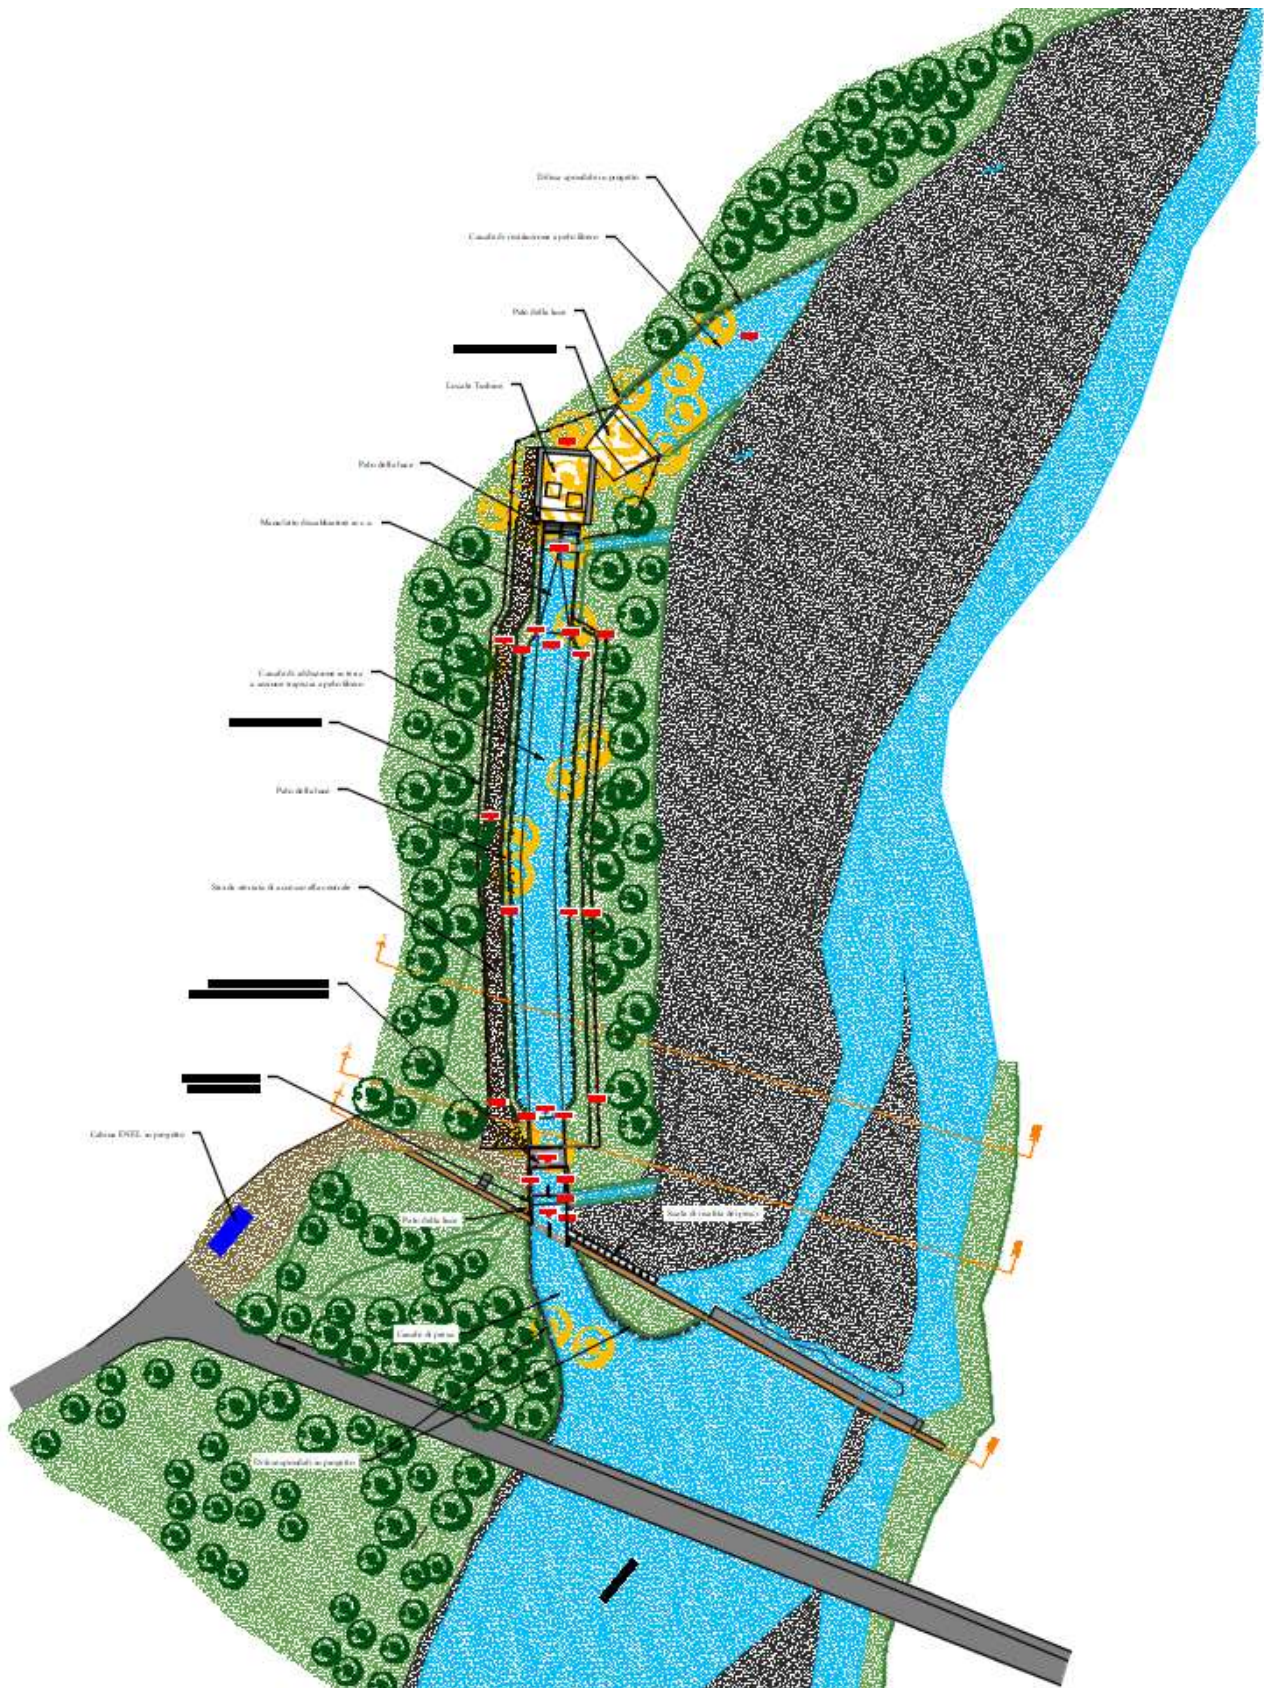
Inquadramento Tavola 02 - SDP - Stato di progetto, planimetria - stralcio
